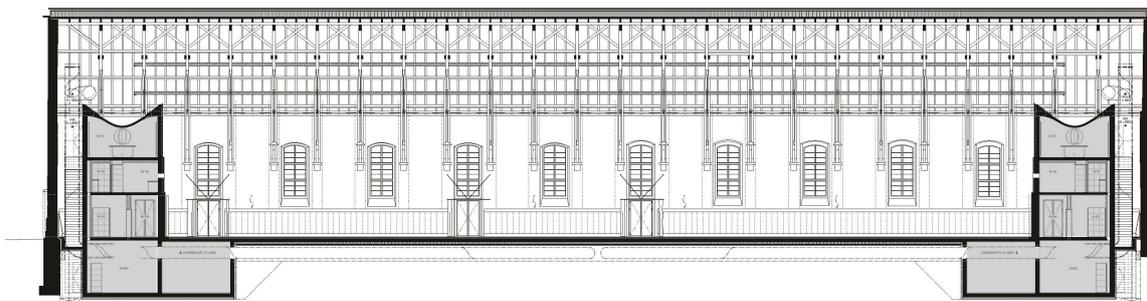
Längsschnitt Alte Reithalle, ohne Massstab
